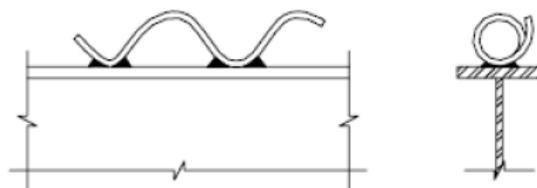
Primeiro conector proposto (Viest, 1960 apud Chaves, 2009)
